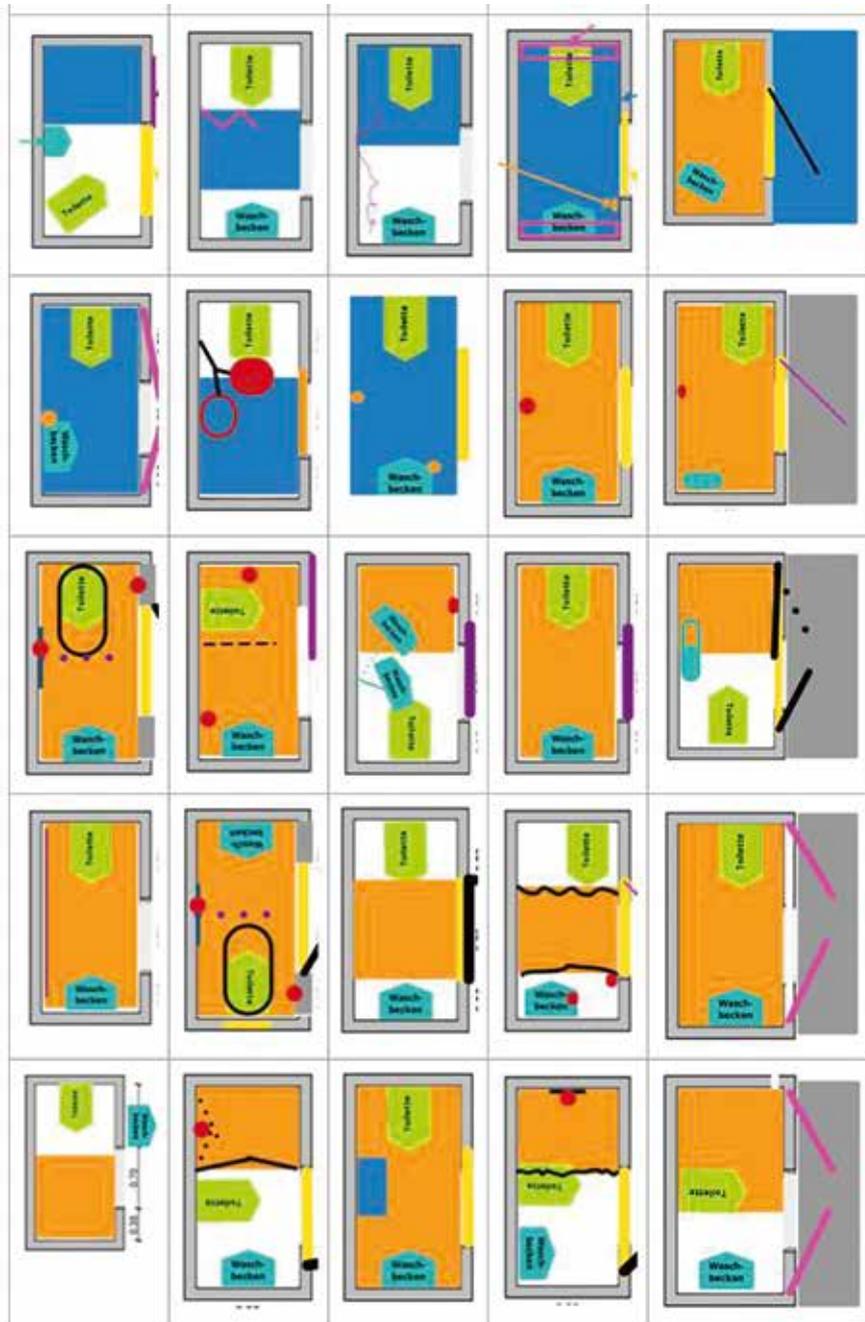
Grundrissvarianten zur Gästetoilette aus den Workshops
